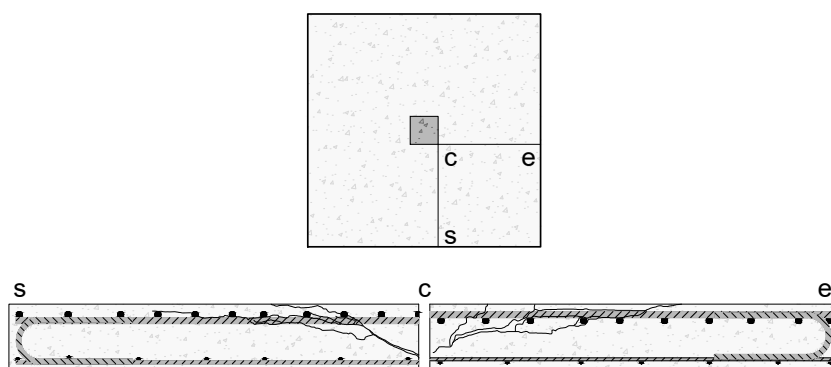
Padrão de fissuração da laje LRSS - cortes
